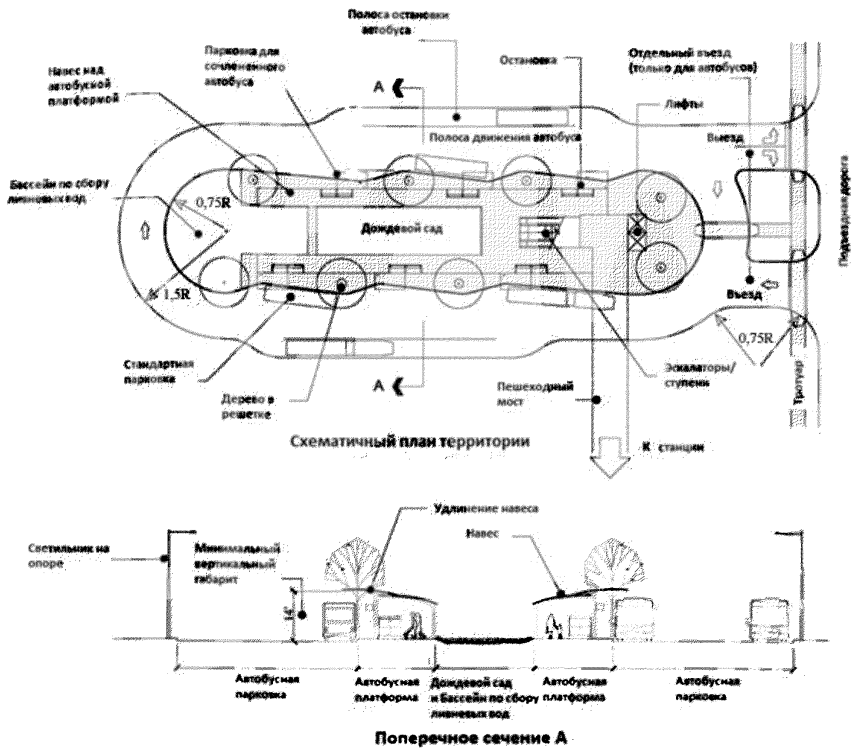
Пример планировочного решения зон посадки и высадки пассажиров с центральной платформой
